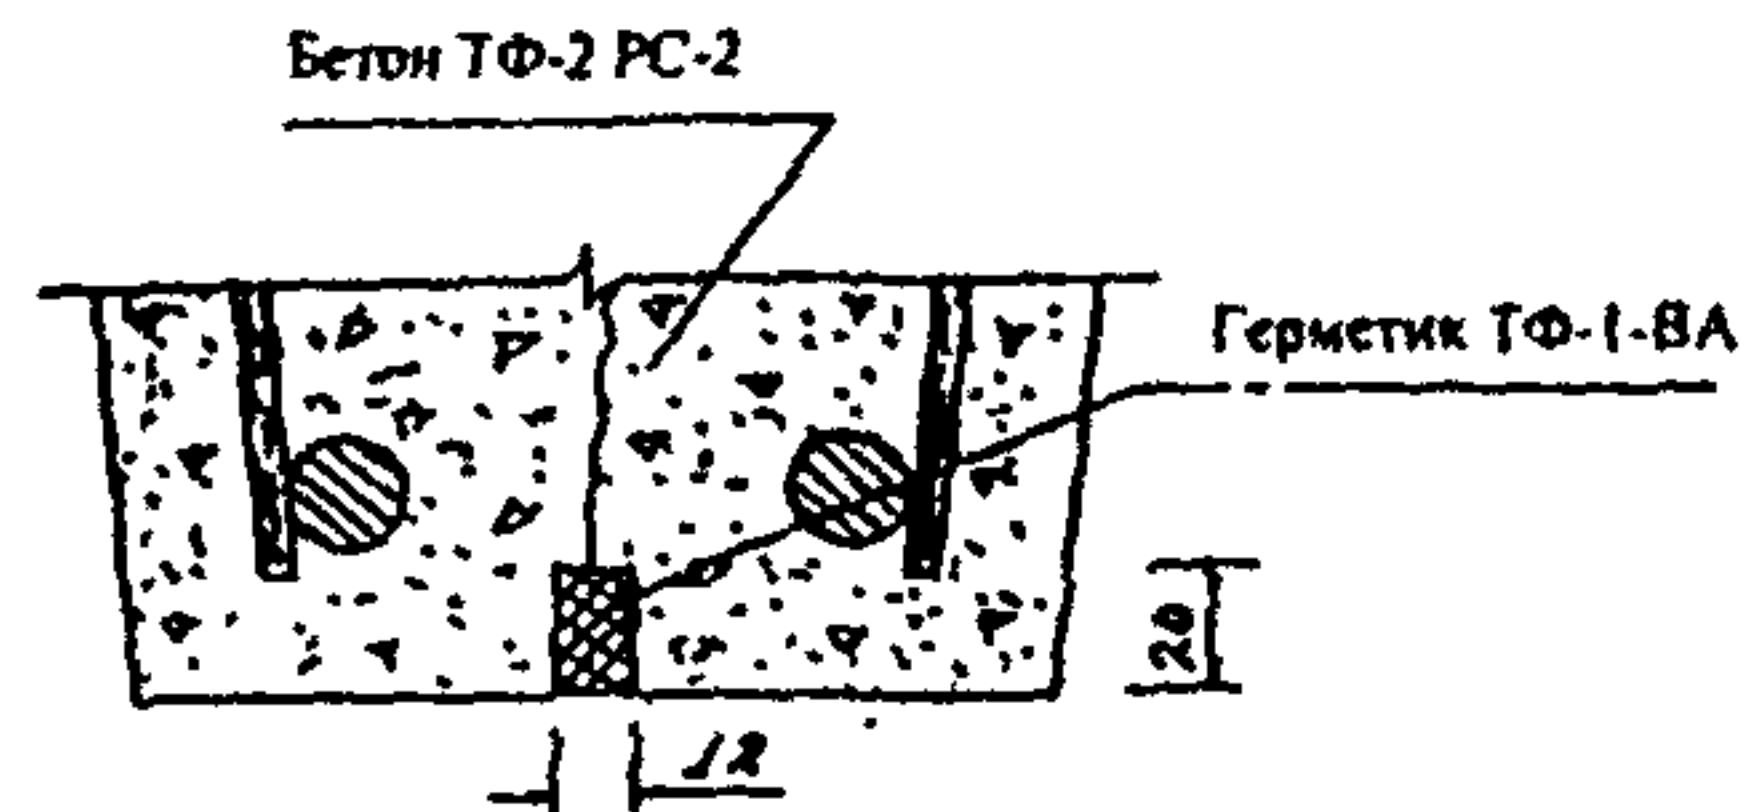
Схема продольных ребер плит покрытия с напрягаемой арматурой (расчеты уточняются проектом):
